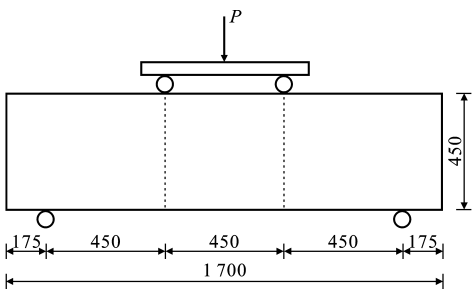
四级配混凝土梁弯拉试验示意(单位:mm)
